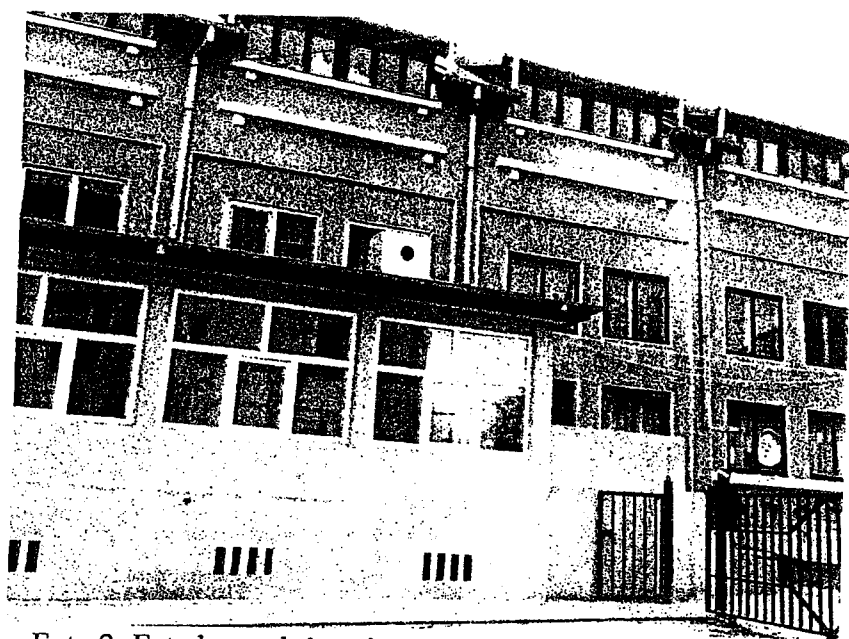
Fațada nord: în prim plan, veranda construită ulterior
